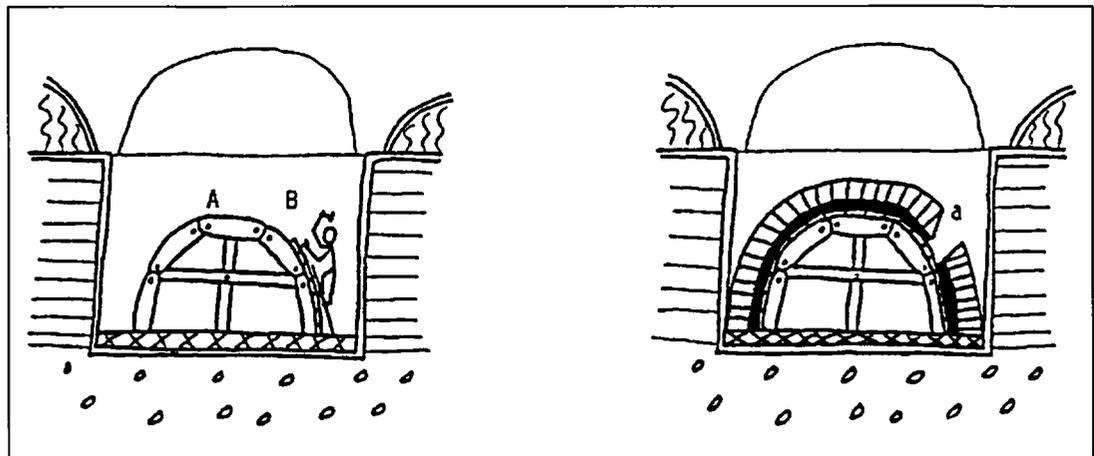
Pose du radier et construction de la voûte (a) sur un coffrage en bois (A)
